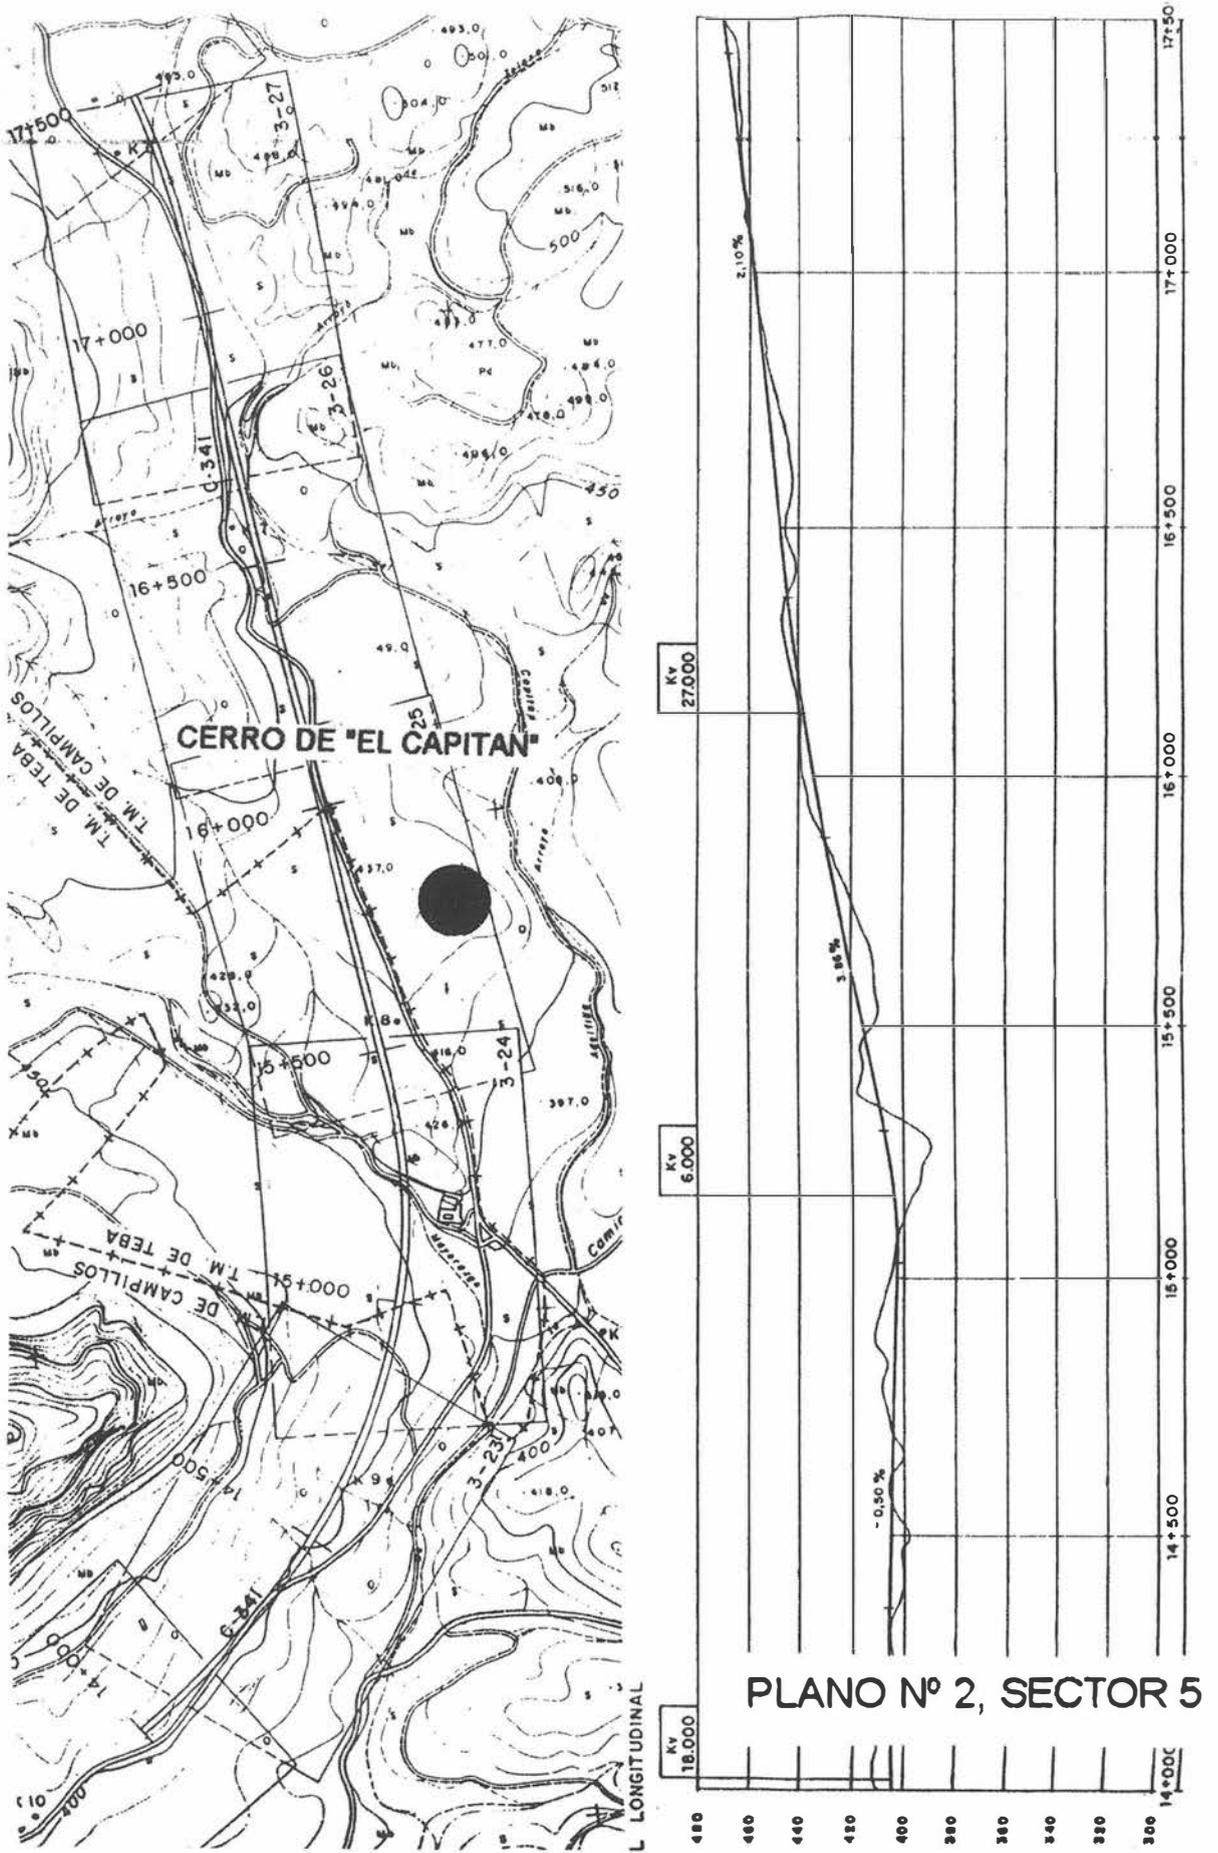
Planta y sección de la traza con ubicación del Cerro del Capitán.
